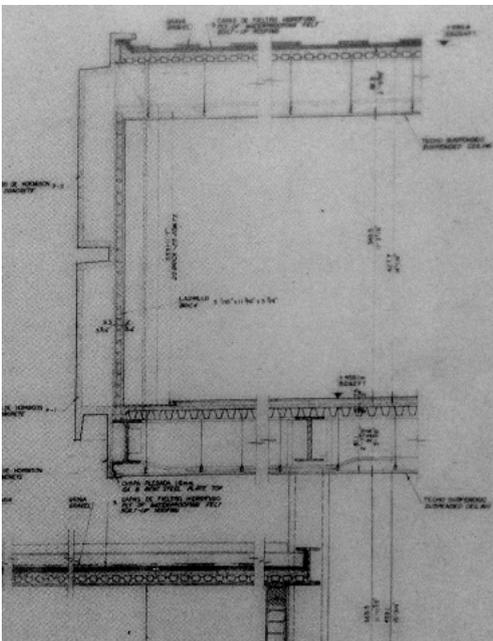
Sección constructiva fachada prefabricada de la primera planta.
